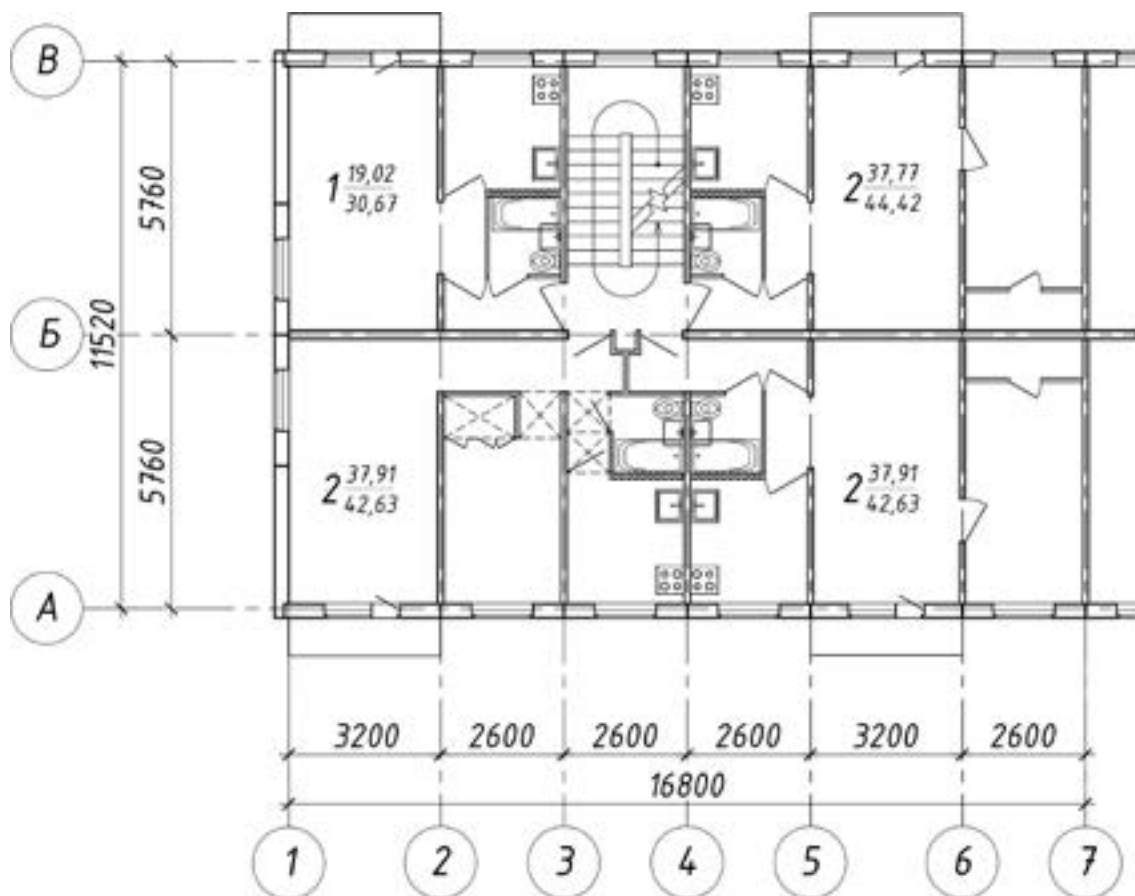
Планировочное решение крупнопанельного жилого дома 464-й серии
